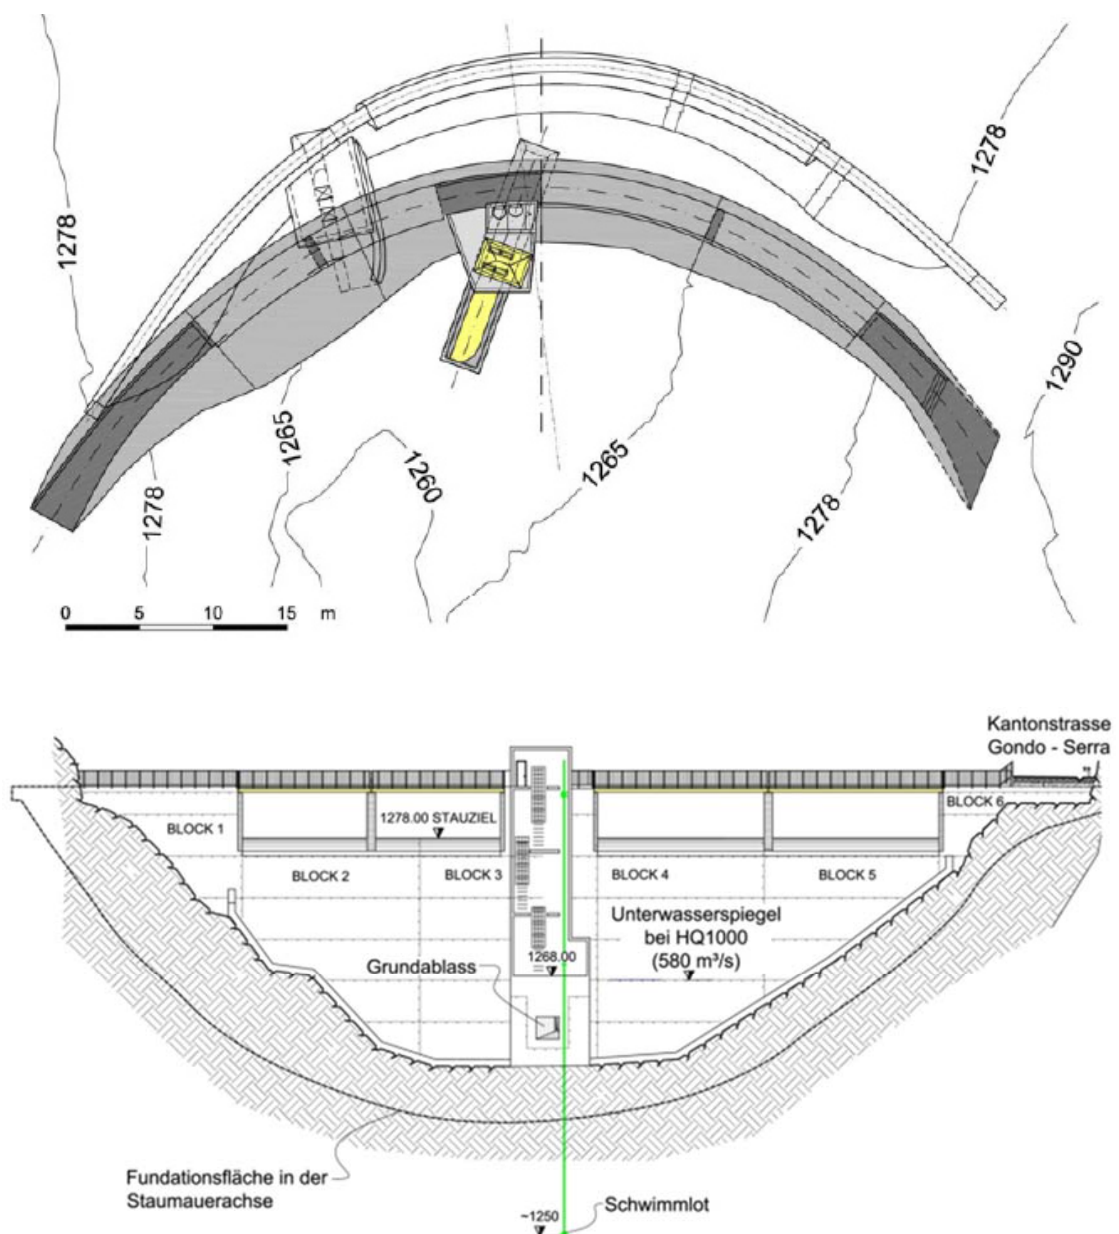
Vue en plan et élévation du nouveau barrage de Sera.
